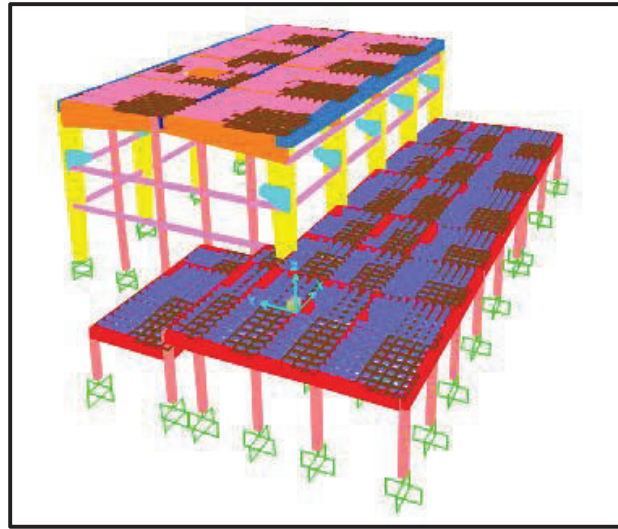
Definición de la sección acartelada de la viga central de los extremos que conectan los pórticos en SAP2000
